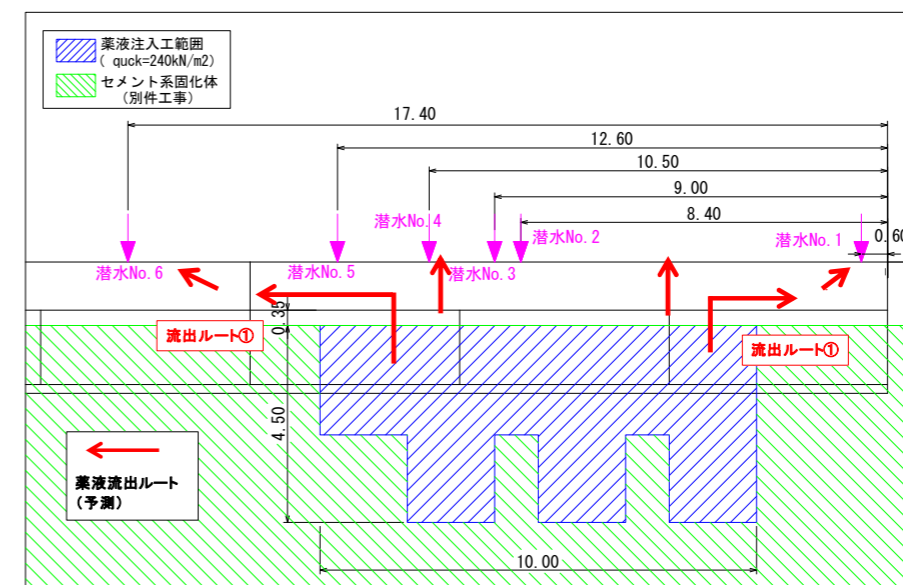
潜水調査位置と流出ルートの想定 (平面図)
